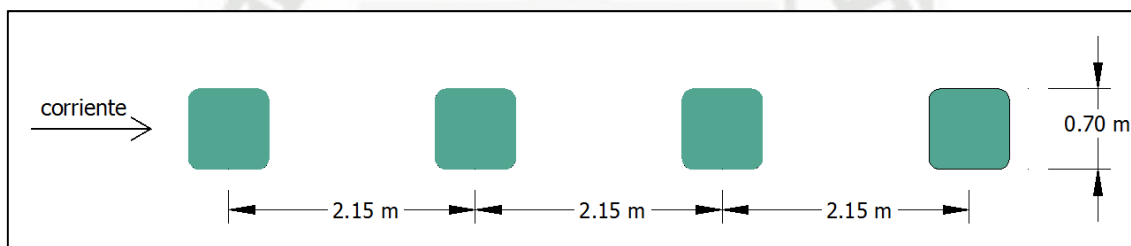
7, Sección de Pila puente “Rio Seco”. ^{PA}
